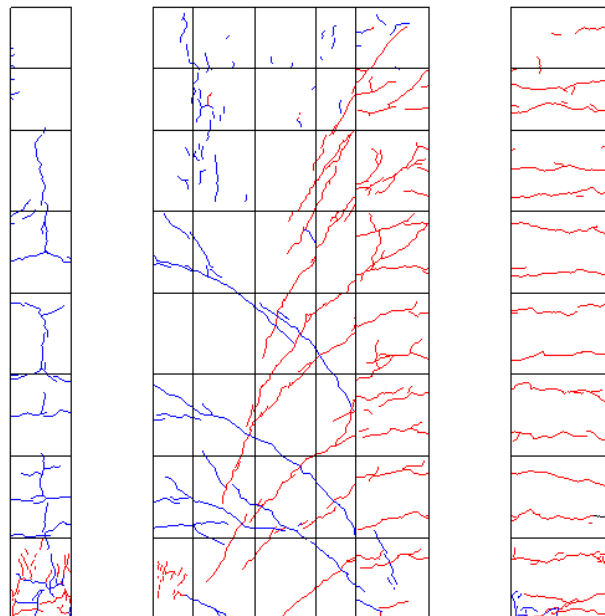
R=-1/67②ひび割れ図
